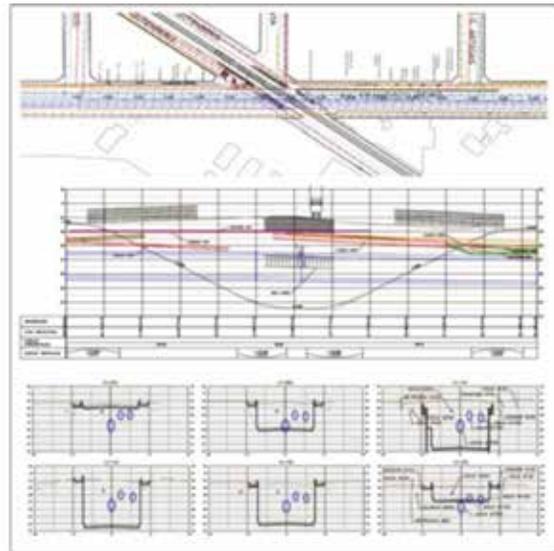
Resultado Final: Planta, Corte Longitudinal, y secciones transversales.
